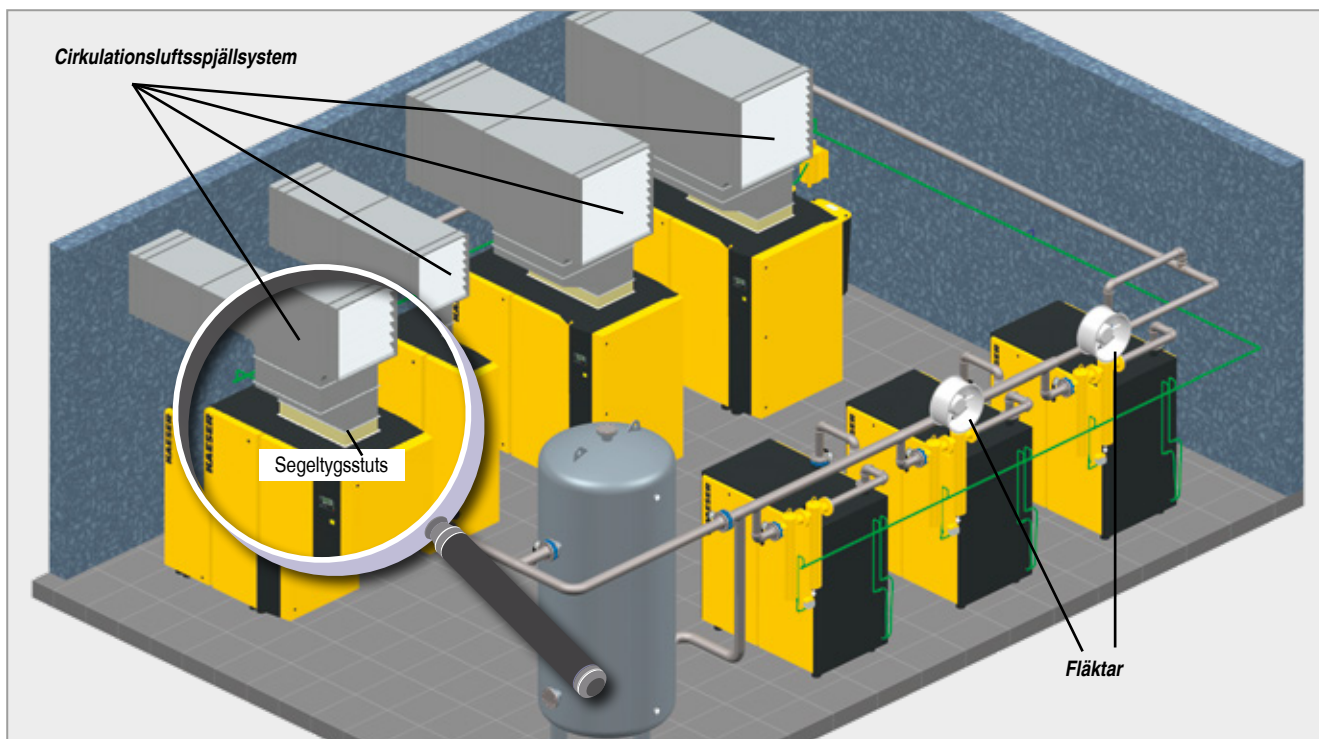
Frånluftssystem med enskild kanal för varje kompressor
